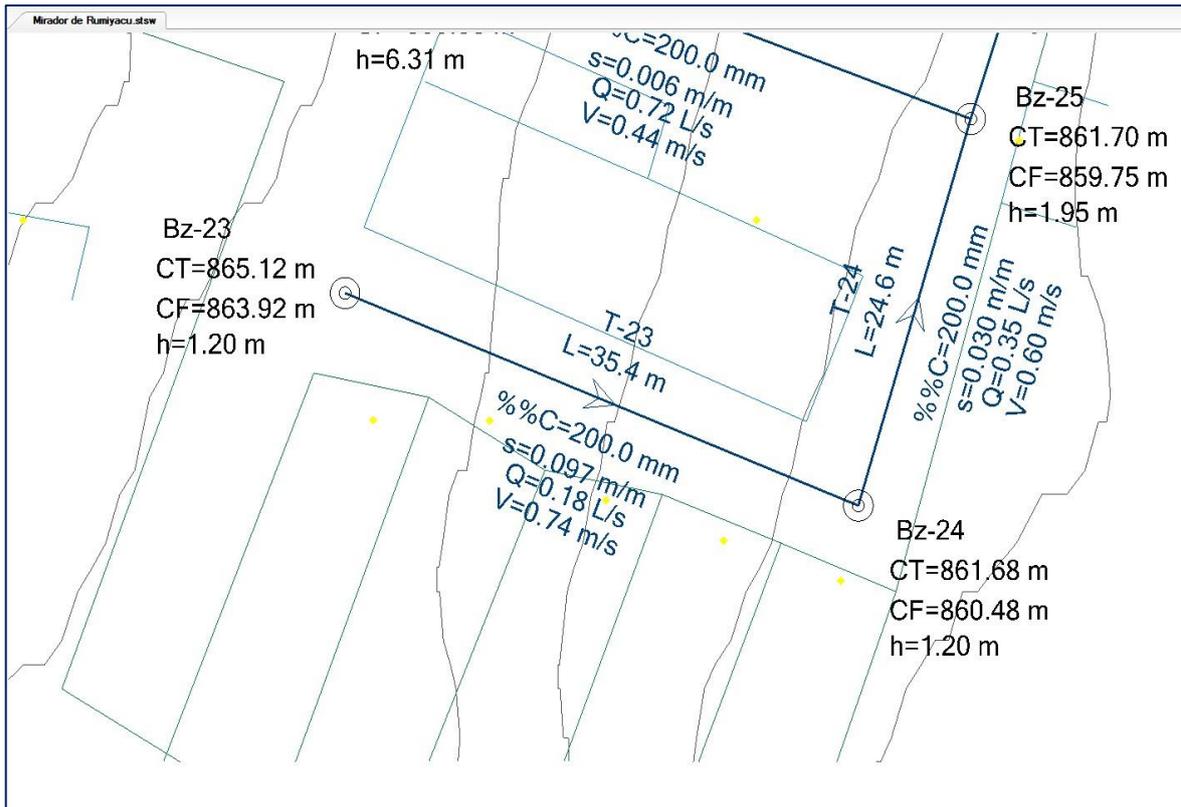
Vista de planta del buzón 23 al 24. (Fuente: Software SEWERCAD)
